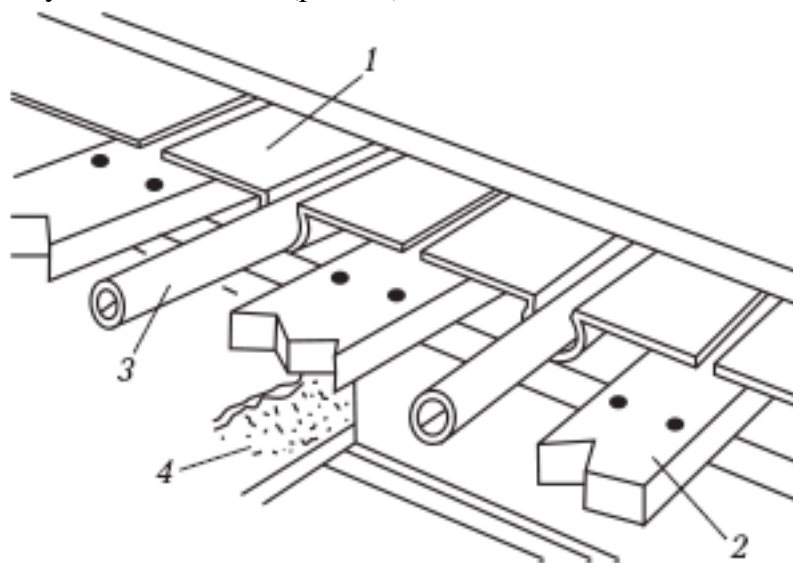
Реечный тип монтажа водяного теплого пола: 1 – теплоотражающая пластина; 2 – лаги; 3 – труба отопления; 4 – теплоизоляция
